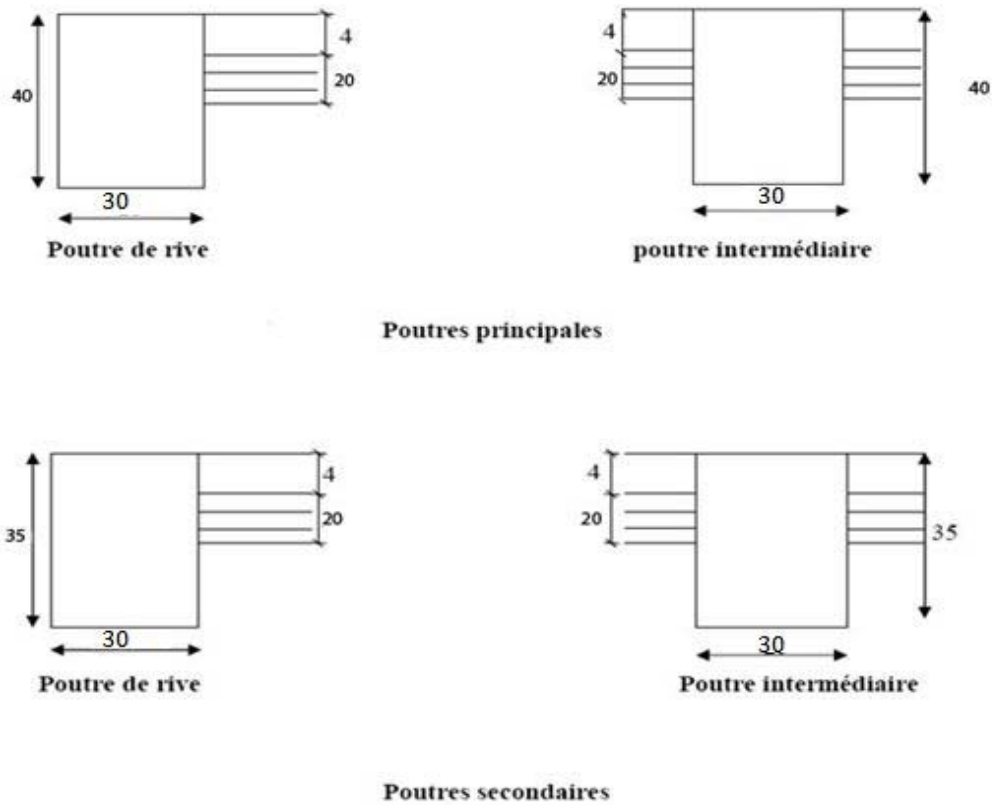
dimensionnement des poutres principales et secondaires.
